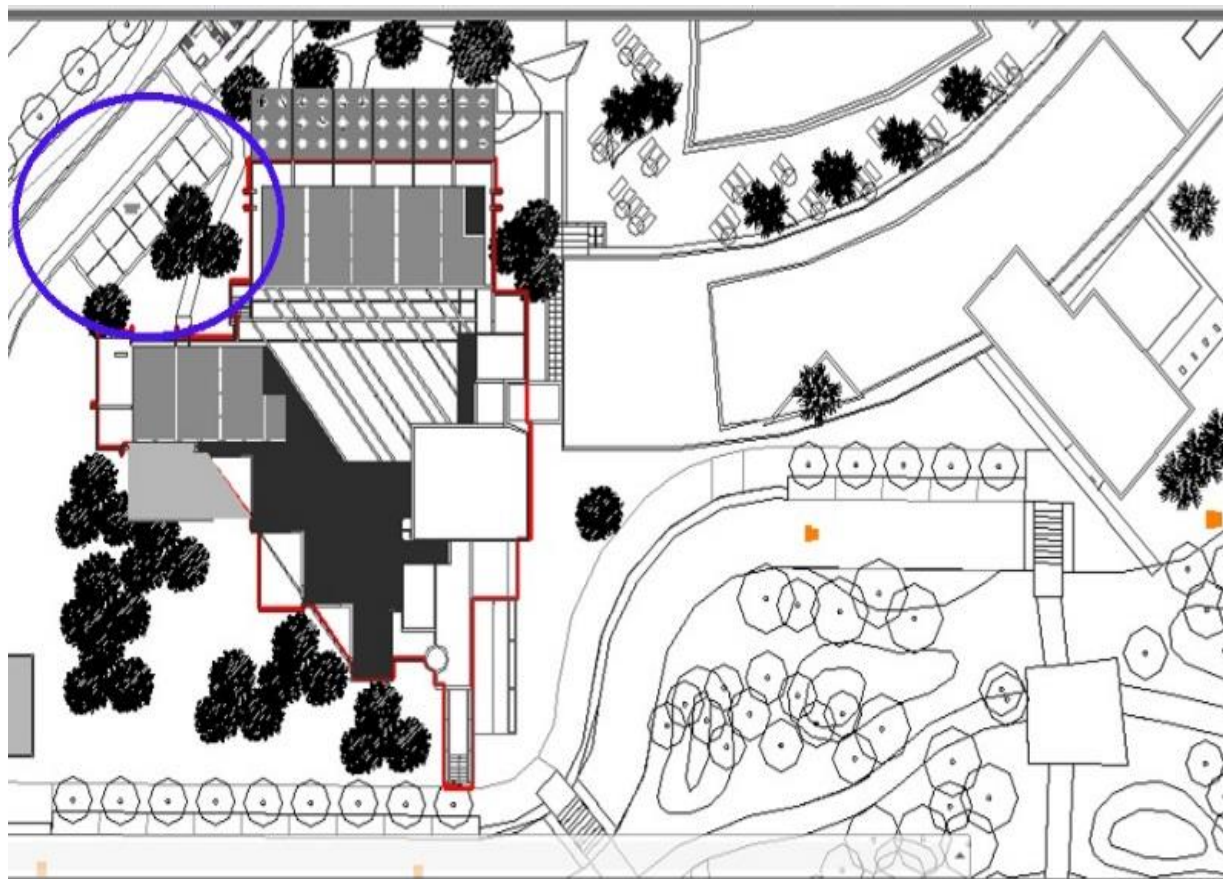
Planta ilustrativa da localização dos chillers (círculo azul).
